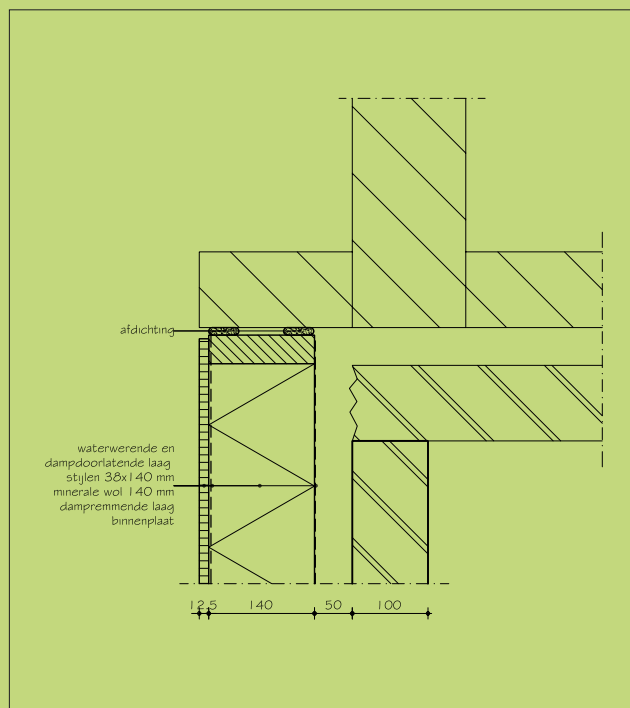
Aansluiting ter plaatse van bovendorpel kozijn.
